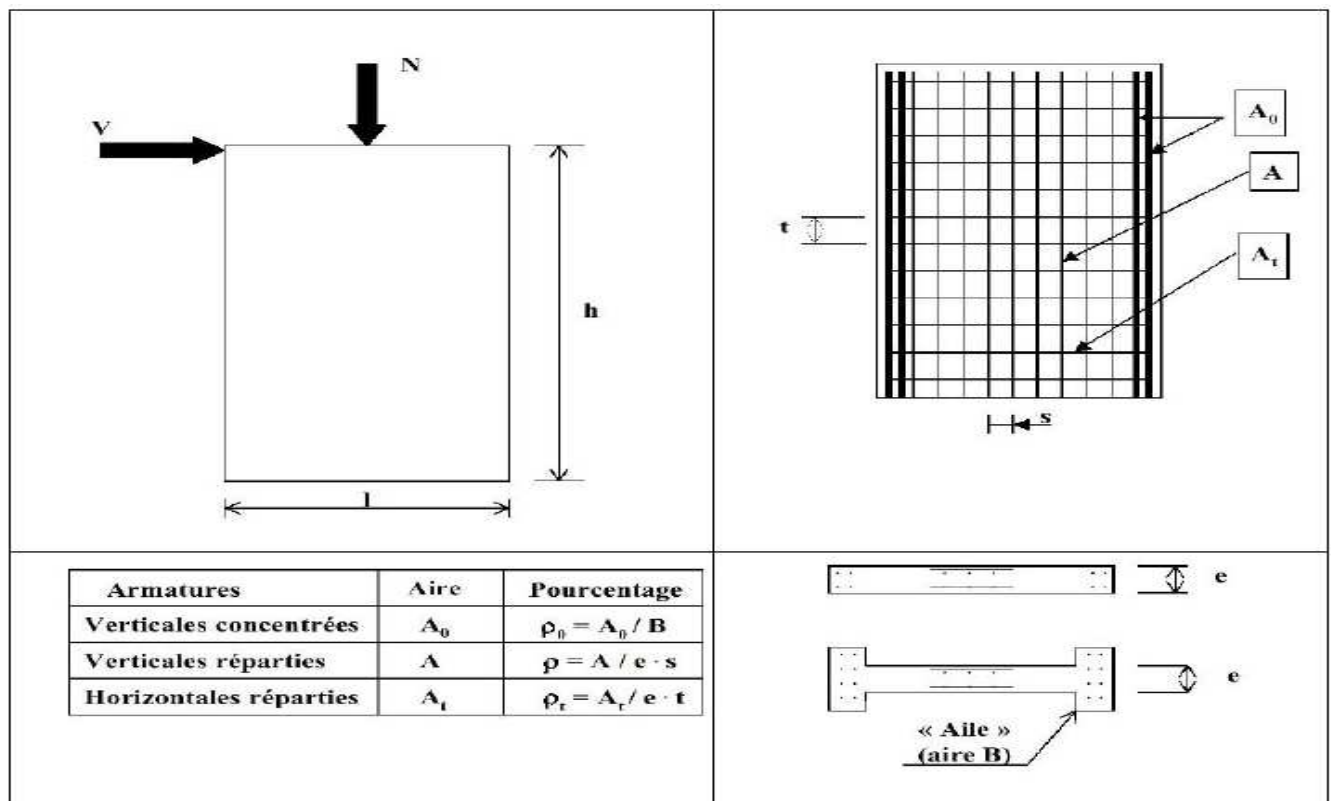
Schéma d'un voile plein et disposition du ferrailage.
